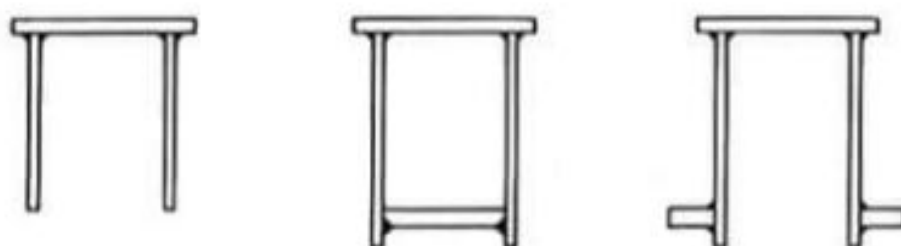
SEÇÕES PARA CORDAS DE TRELIÇAS SOLDADAS
